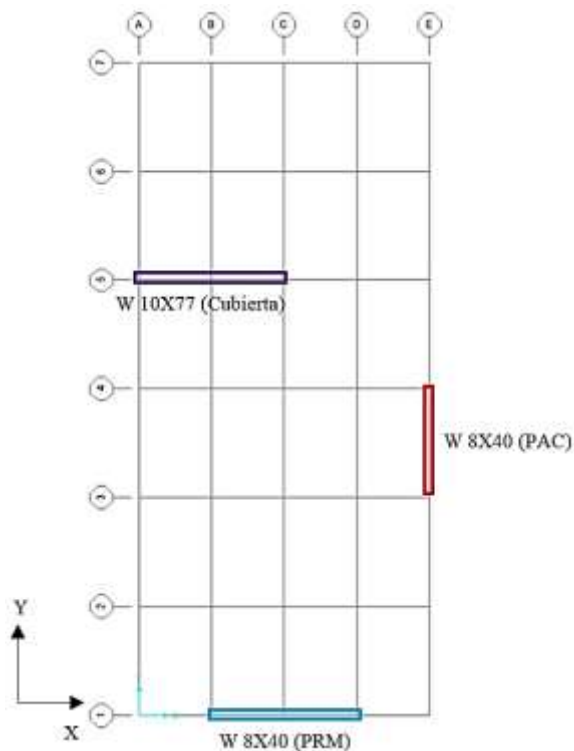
Vigas acorde al sistema estructural a) PRM, b) PAC, c) Viga Cubierta
